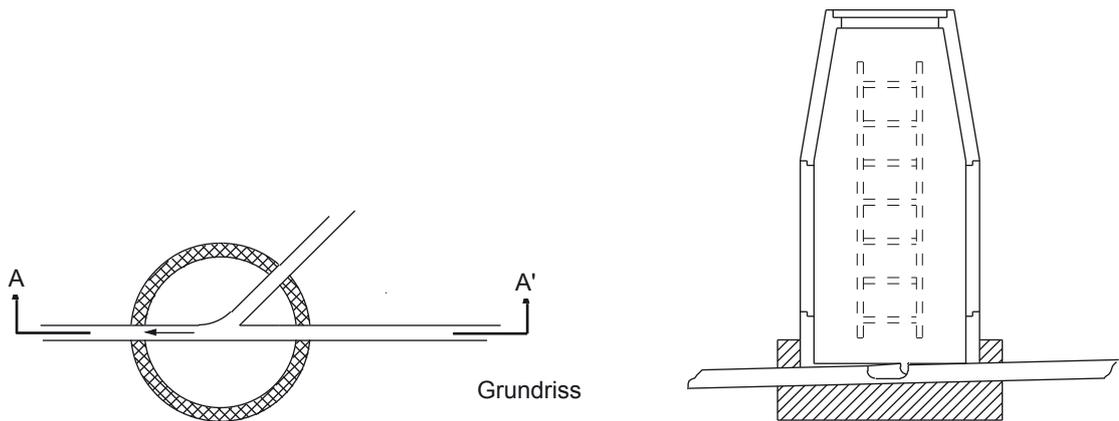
Einsteigschacht in Grundriss und Schnitt
